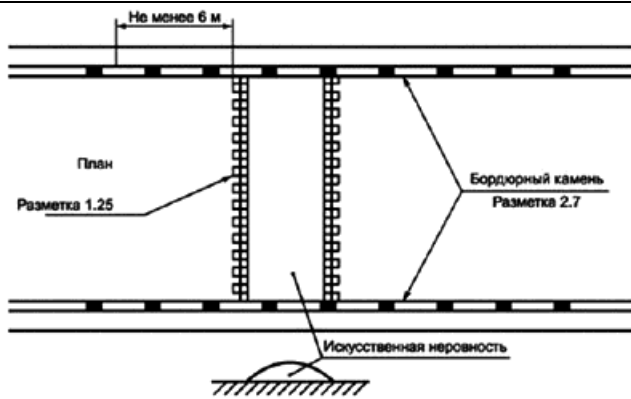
Пример нанесения разметки 1.25 и 2.7 при устройстве сборно-разборной конструкции
